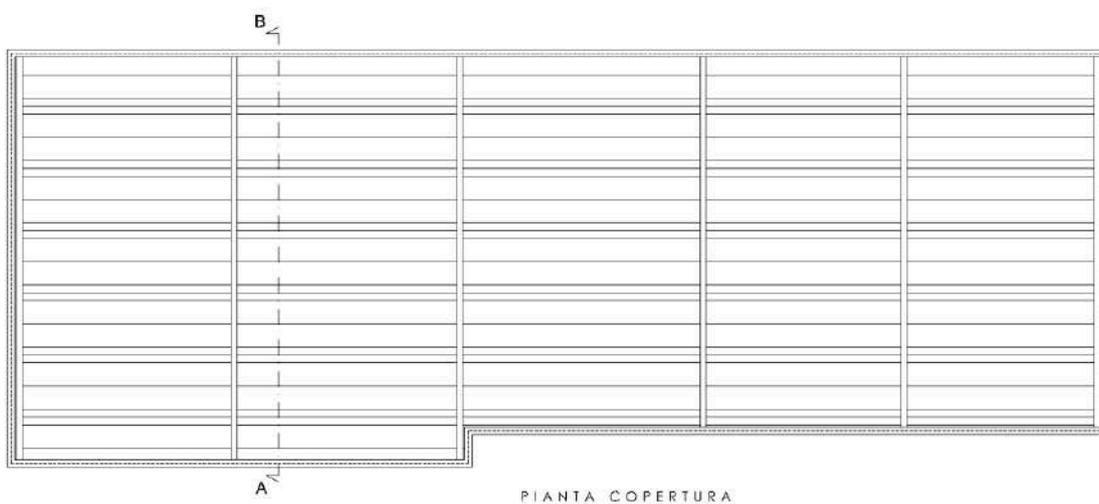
Estratto dell'elaborato del PA E8/A – Tipologie edilizie – Pianta edificio A
